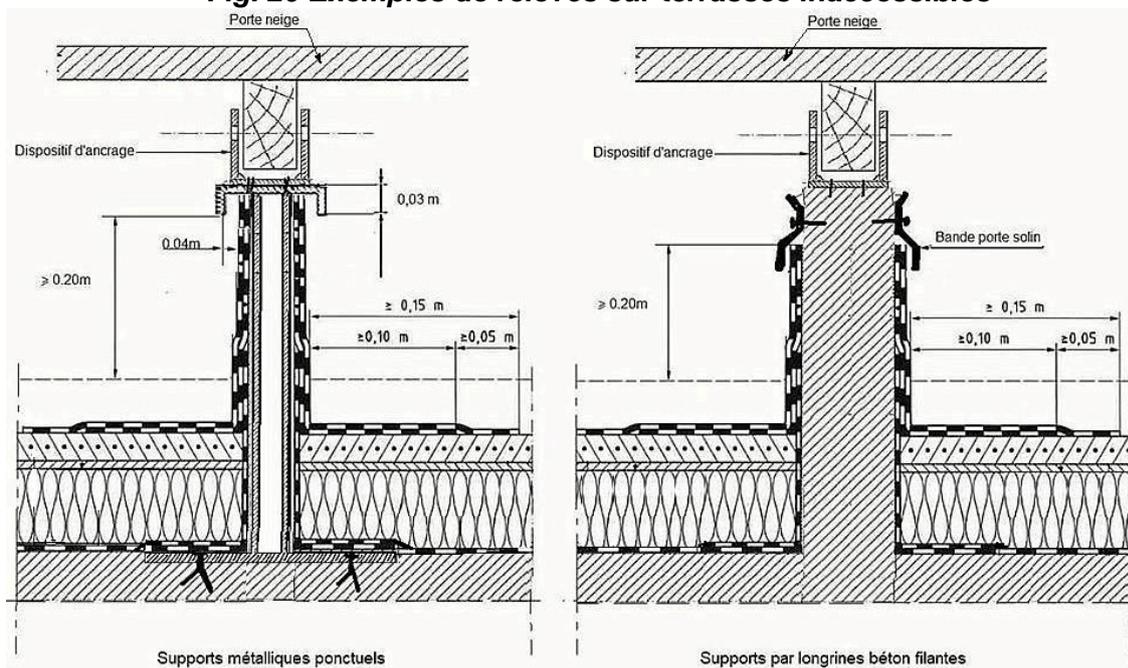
Exemples de supports de portes neiges sur terrasses inaccessibles
